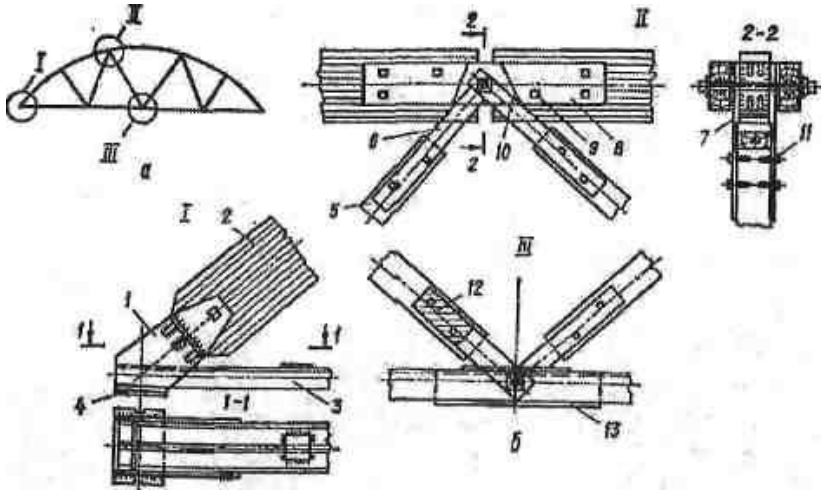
Металодерев'яна сегментна ферма: а – схема ферми; б – вузли; 1– башмак; 2 – верхній пояс; 3 – нижній пояс; 4– опорна плита; 5– кісець; 6 – планка; 7 – зварний башмак; 8 – дерев'яна накладка; 9 – кріпильні болти; 10 – виріз у накладці; 11 – глухі нагелі; 12 – сталеві накладки; 13 – стикові накладки нижнього поясу
